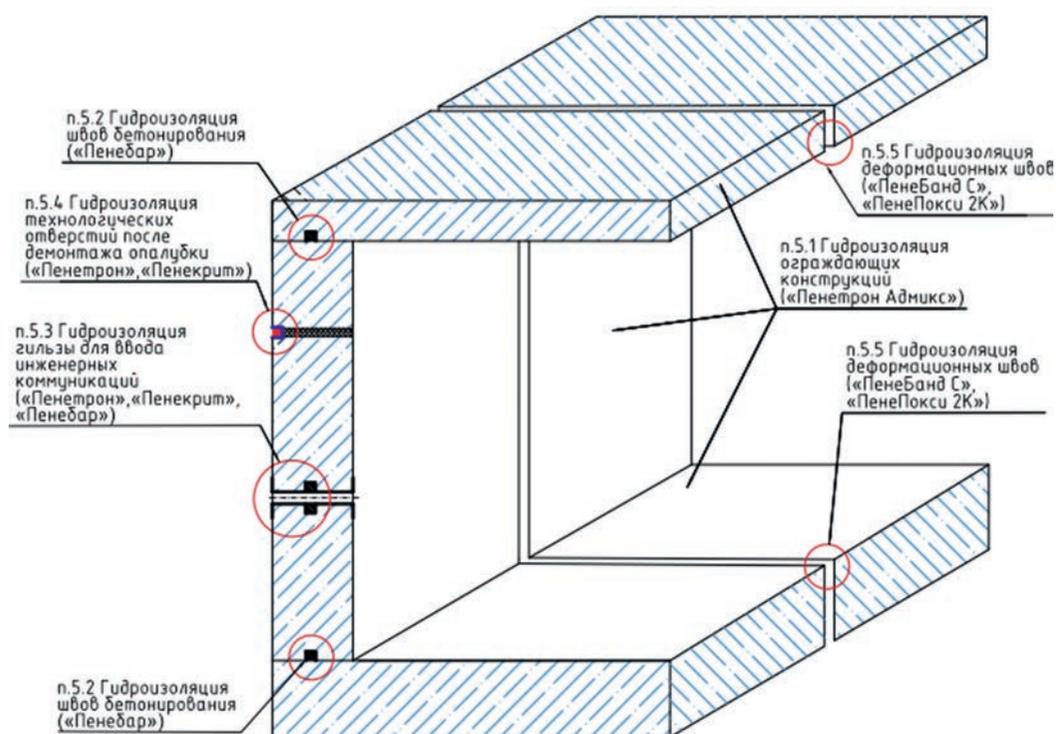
Схема гидроизоляции конструкции на стадии строительства
